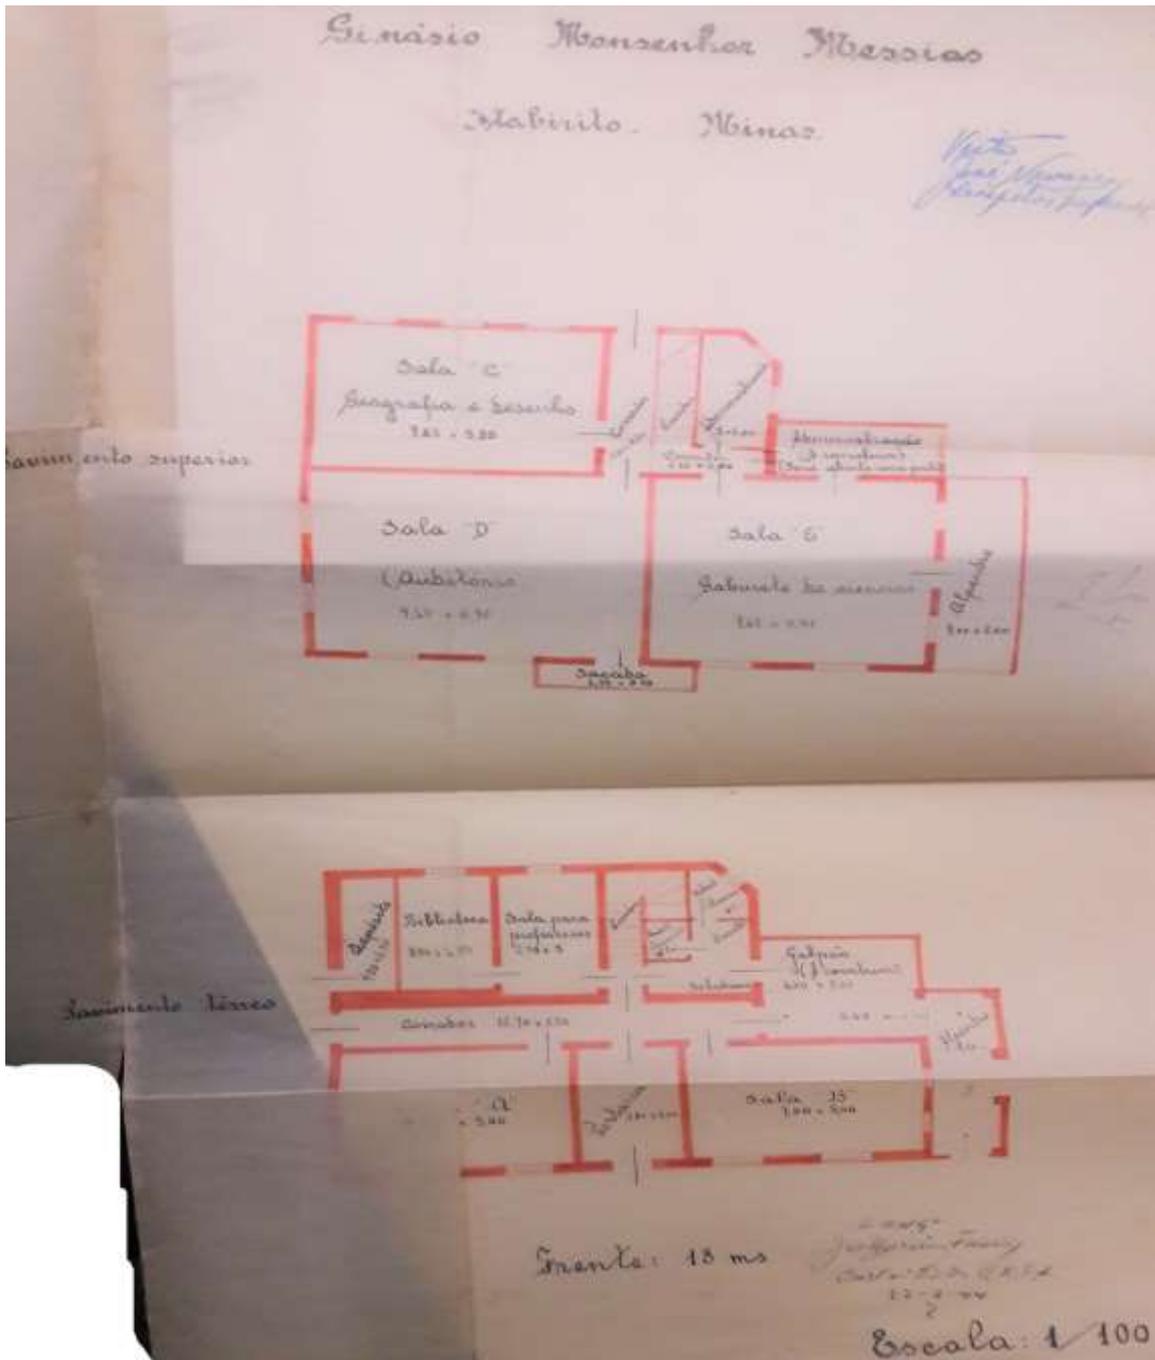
Primeira planta baixa do primeiro pavilhão do Ginásio Monsenhor Messias.
